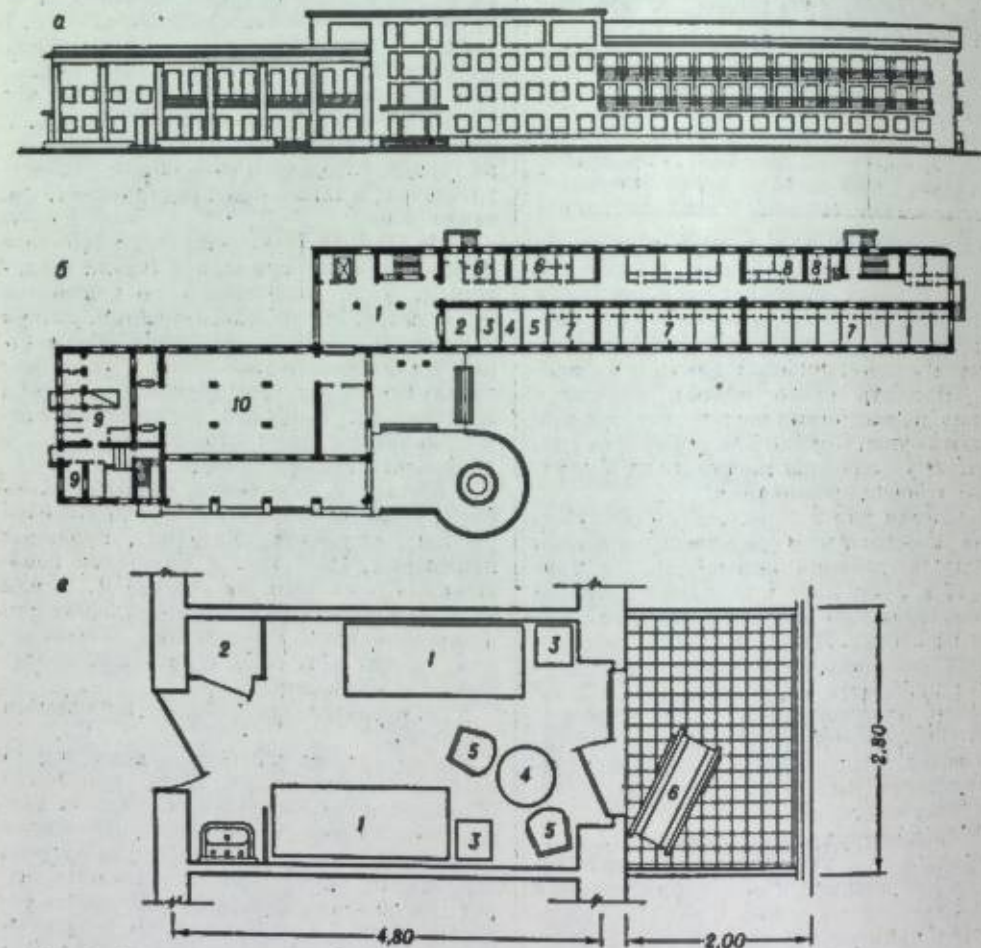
Типовой проект дома отдыха: а — фасад; б — план 1-го этажа (1 — вестибюль; 2 — гардероб; 3 — камера хранения; 4 — парикмахерская; 5 — комната врача; 6 — душ; 7 — комнаты на 2 чел.; 8 — санузлы; 9 — помещения кухни; 10 — обеденный зал); в — план спальной комнаты (1 — кровать; 2 — шкаф; 3 — тумбочка; 4 — стол круглый; 5 — стул полумягкий; 6 — шезлонг).
